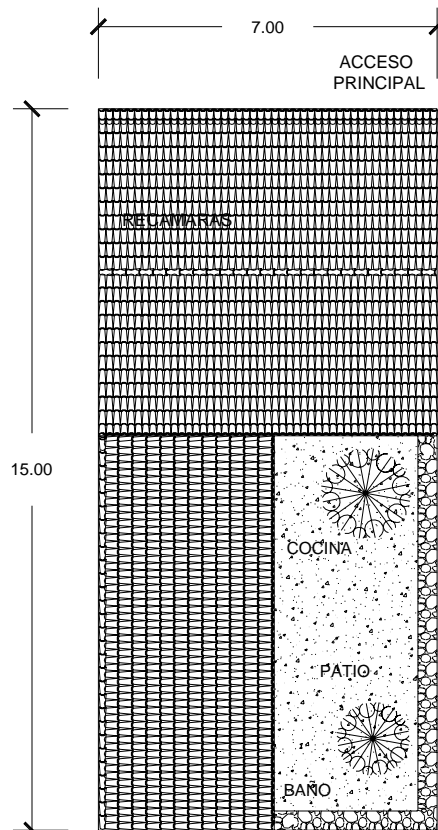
Planta tipo del esquema espacial de la vivienda
